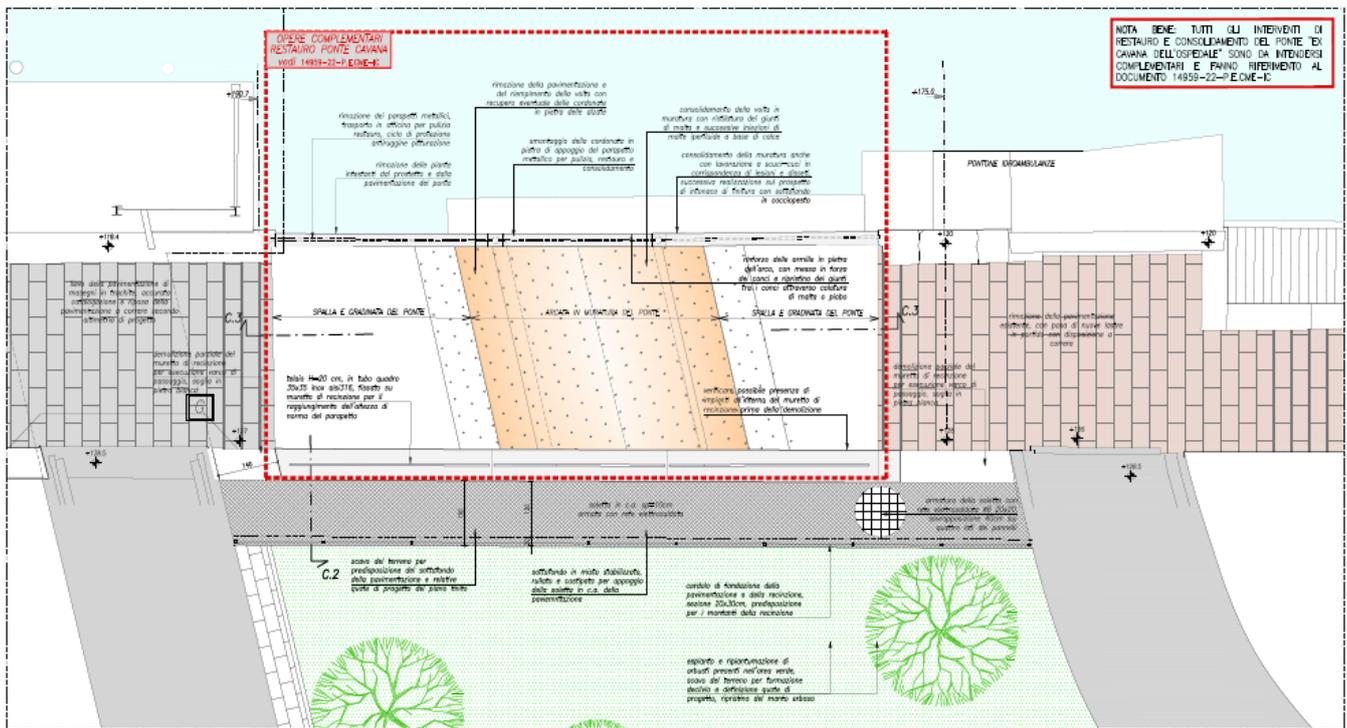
Planimetria di progetto con individuazione del Ponte della Cavana dell'Ospedale, con indicazione delle lavorazioni
